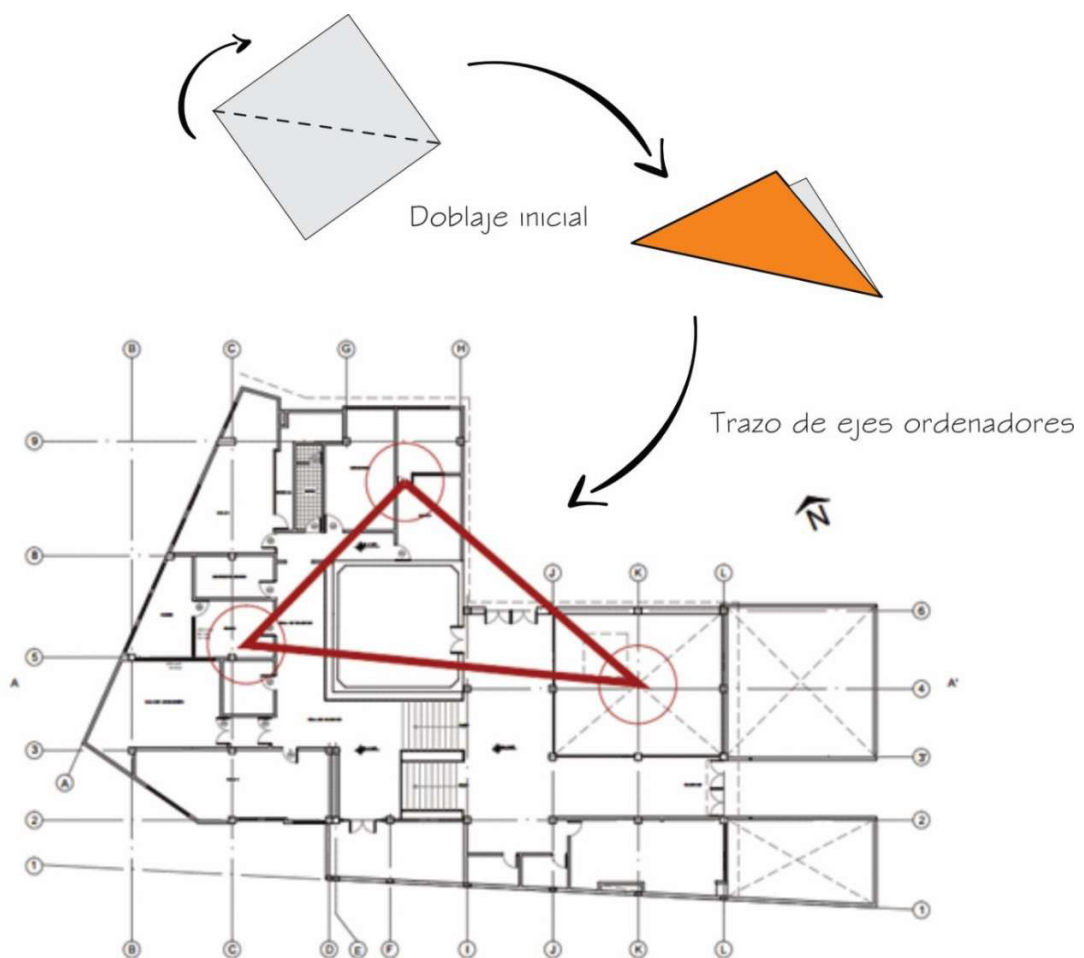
Planta Baja, definición de Ejes Ordenadores del modelo teórico.
